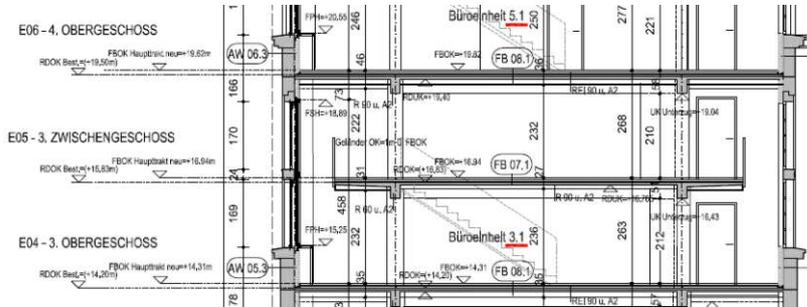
Planquerschnitt Büroloft 3. Obergeschoss und 3. Zwischengeschoss Planverfasser: ostertag ARCHITECTS zt gmbh
